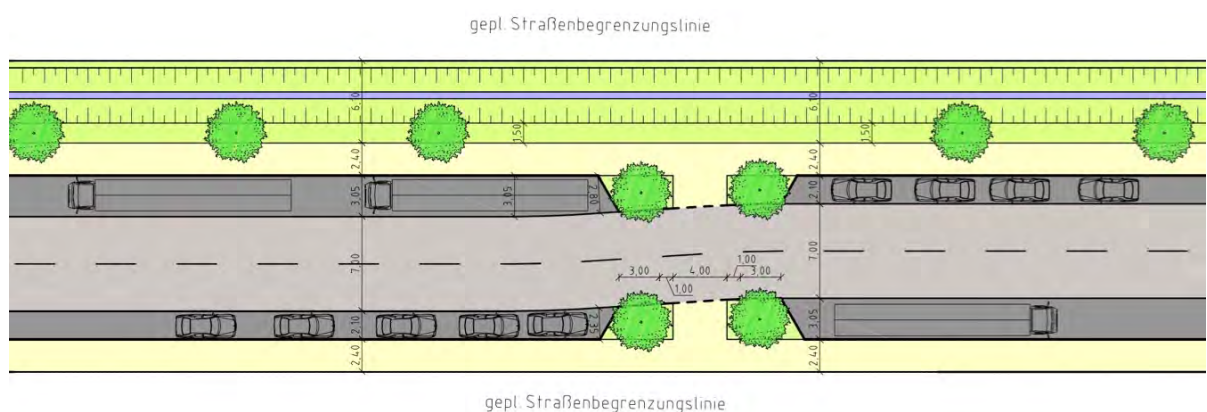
Geplanter Straßenquerschnitt, wfw nord consult, Hamburg 28.09.2016.
